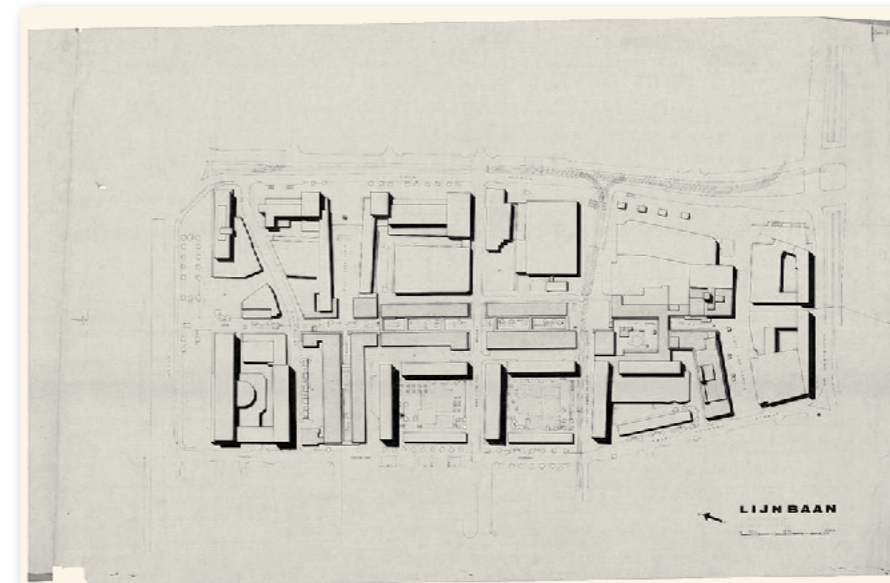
Van den Broek & Bakema Lijnbaan. Planta de la actuación. 1953
